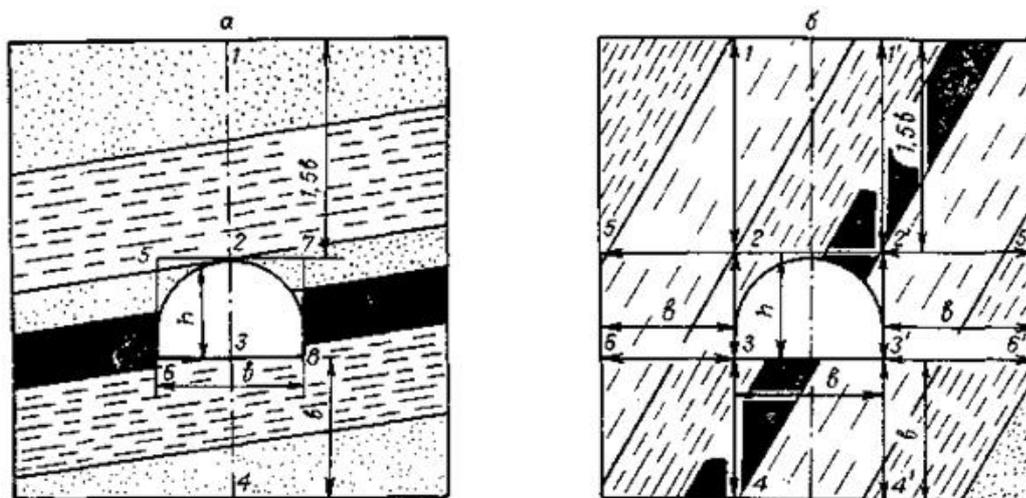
Схемы к определению расчетного сопротивления пород сжатию: а - пологое и наклонное, б - крутонаклонное и крутое падение
